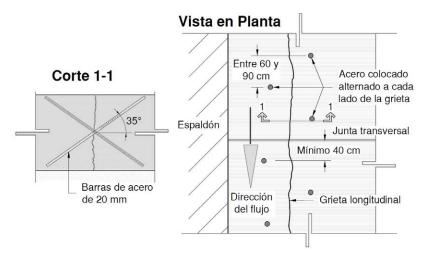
Esquema de la reparación de cosido cruzado juntas o grietas Fuente: Adaptado del Manual de Reparación y Mantenimiento de Pavimentos. Instituto del Cemento Portland Argentino, 2016.
